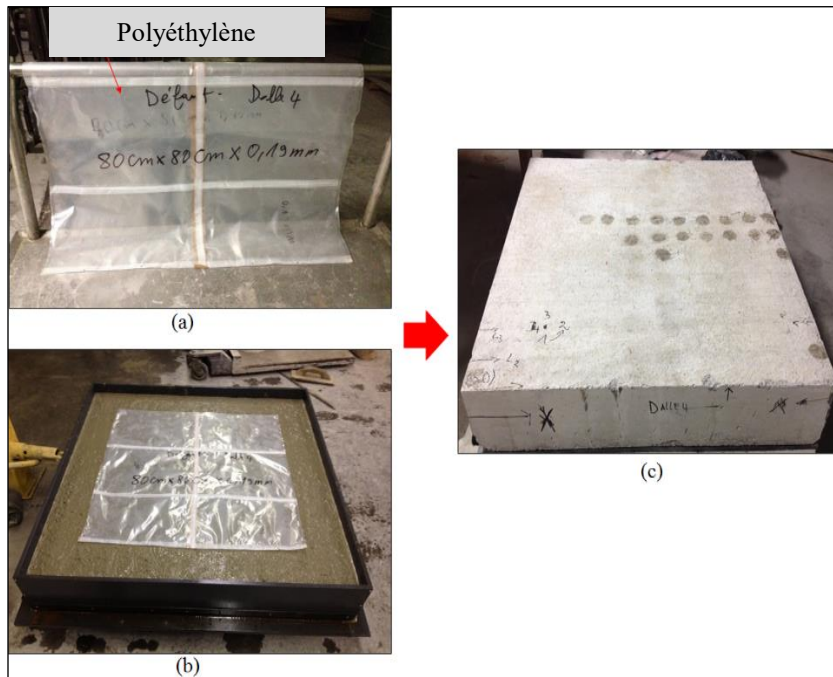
Dalle N° 4, (a) Mise en place du béton, (b) Remplissage du moule, (c) Dalle monolithique finale.
